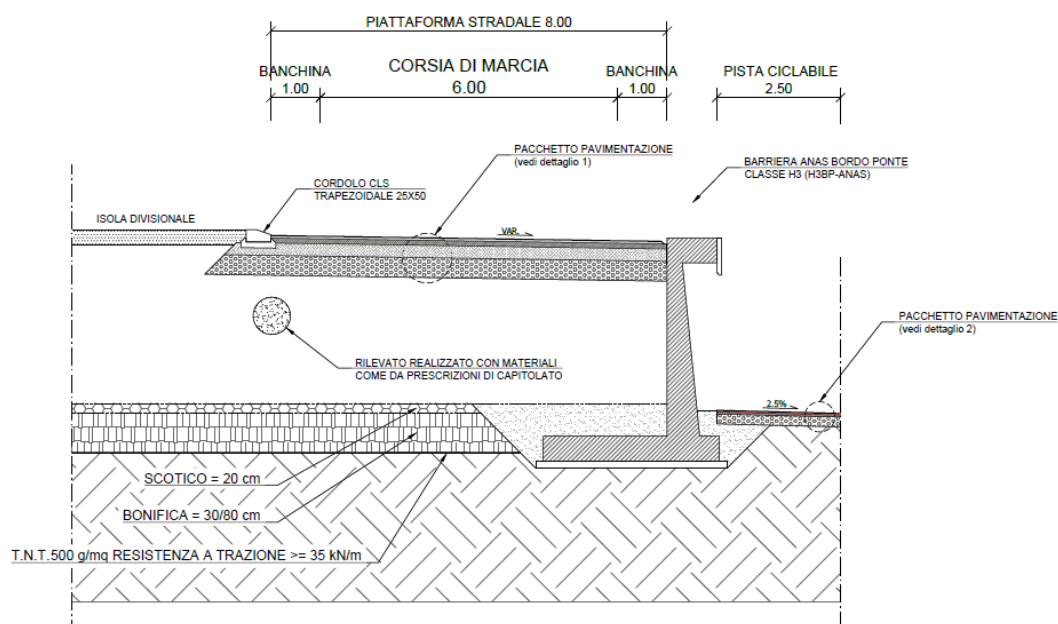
Sezione tipo con pista ciclabile e Muro (OS.02)
